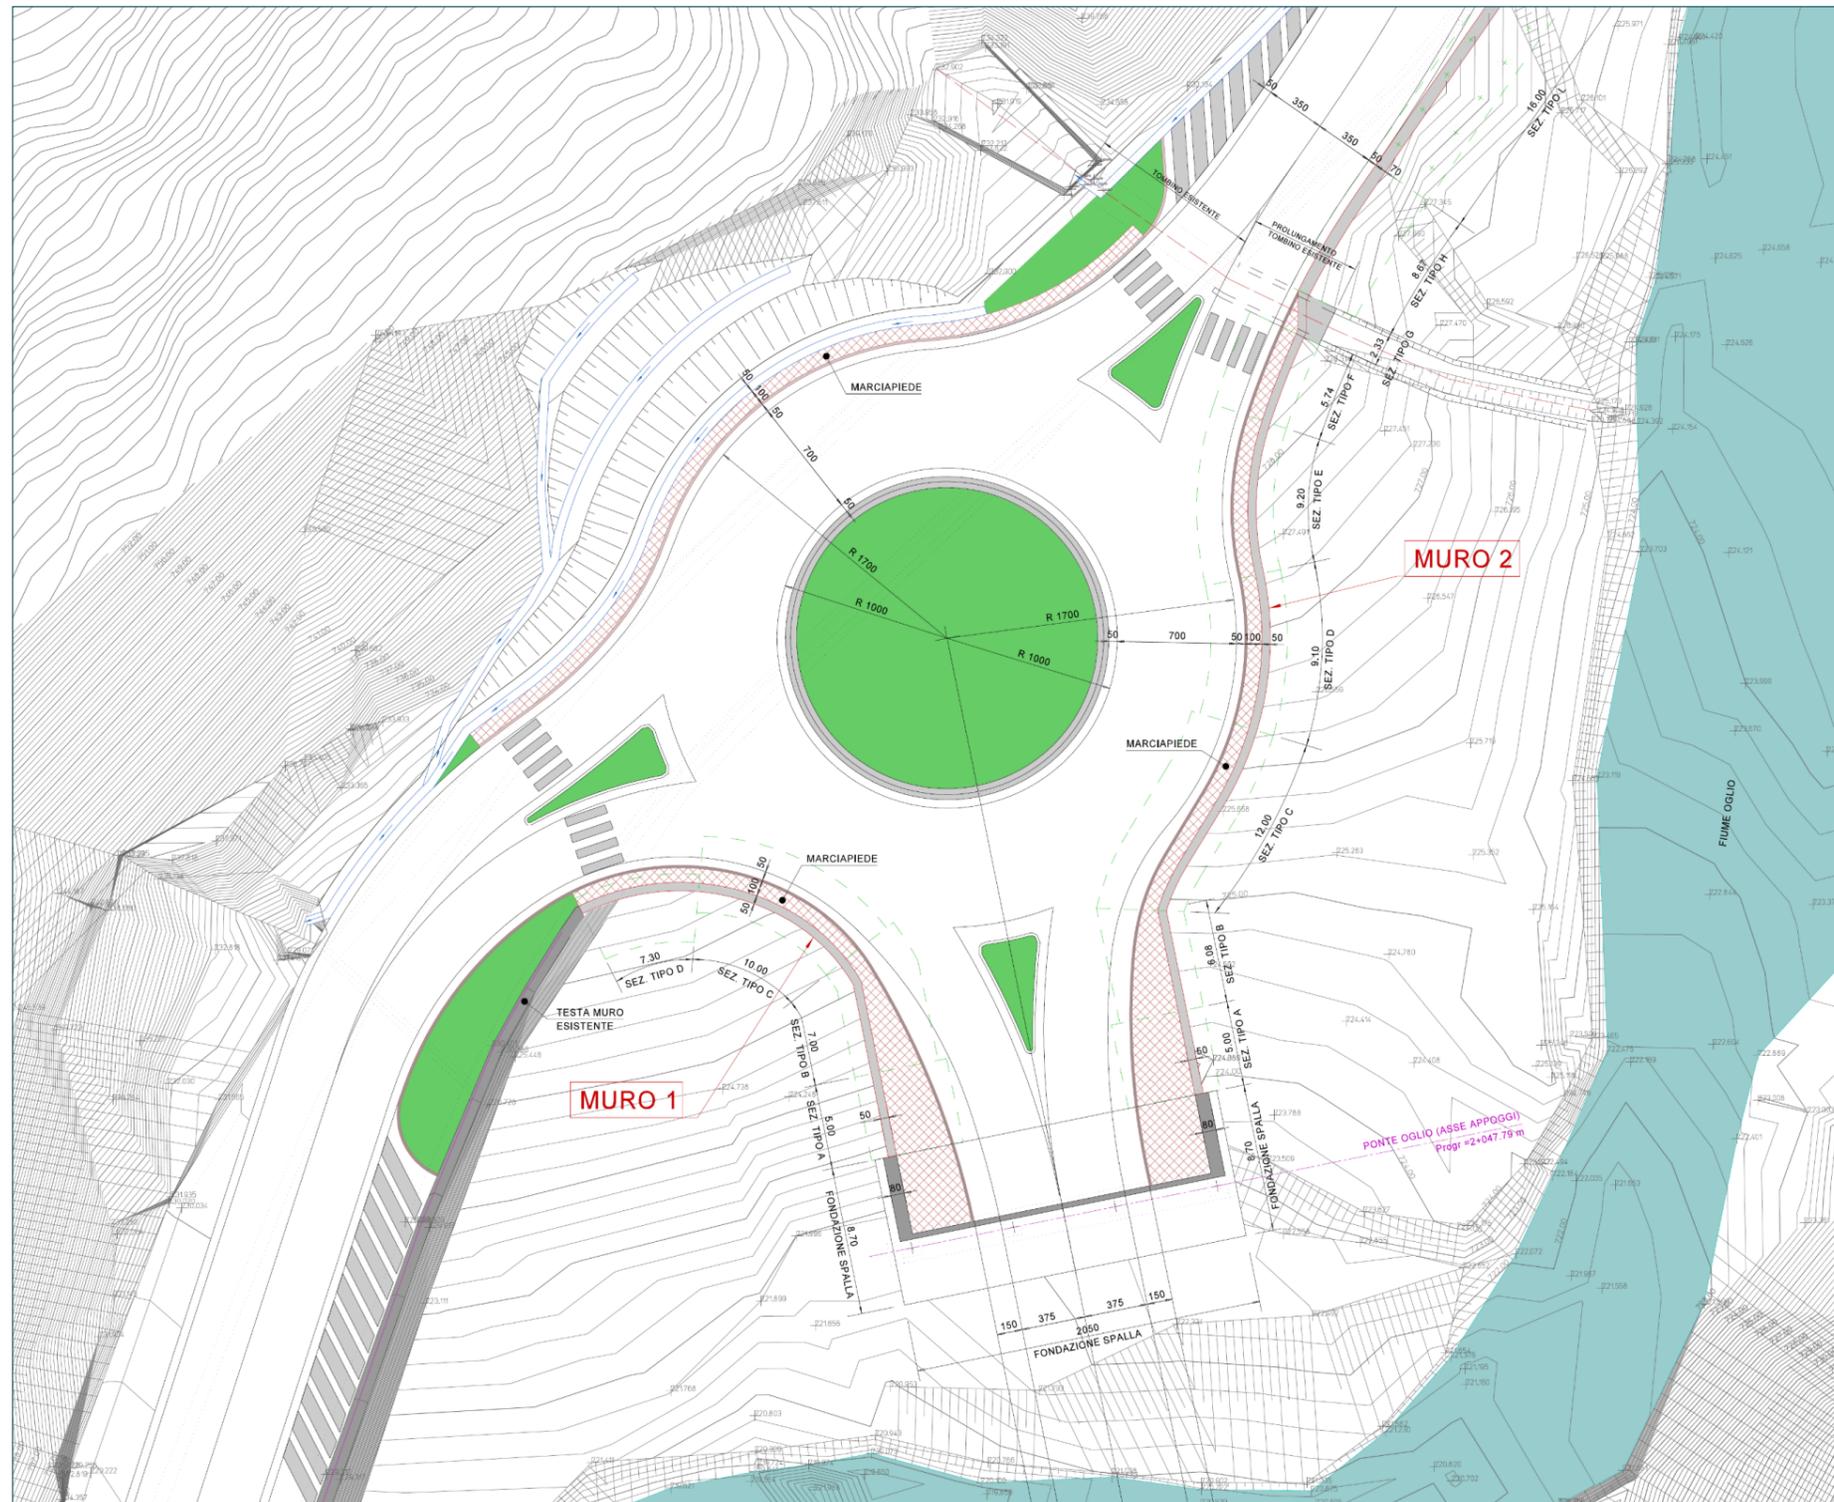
Ponte sul Fiume Oglio – Muri andatori – Pianta
